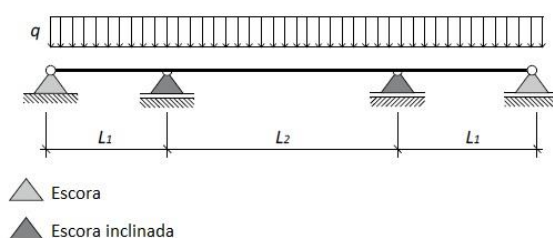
Esquema estático utilizado para o dimensionamento da travessa superior do pórtico de suporte, escoras e escoras inclinadas.
